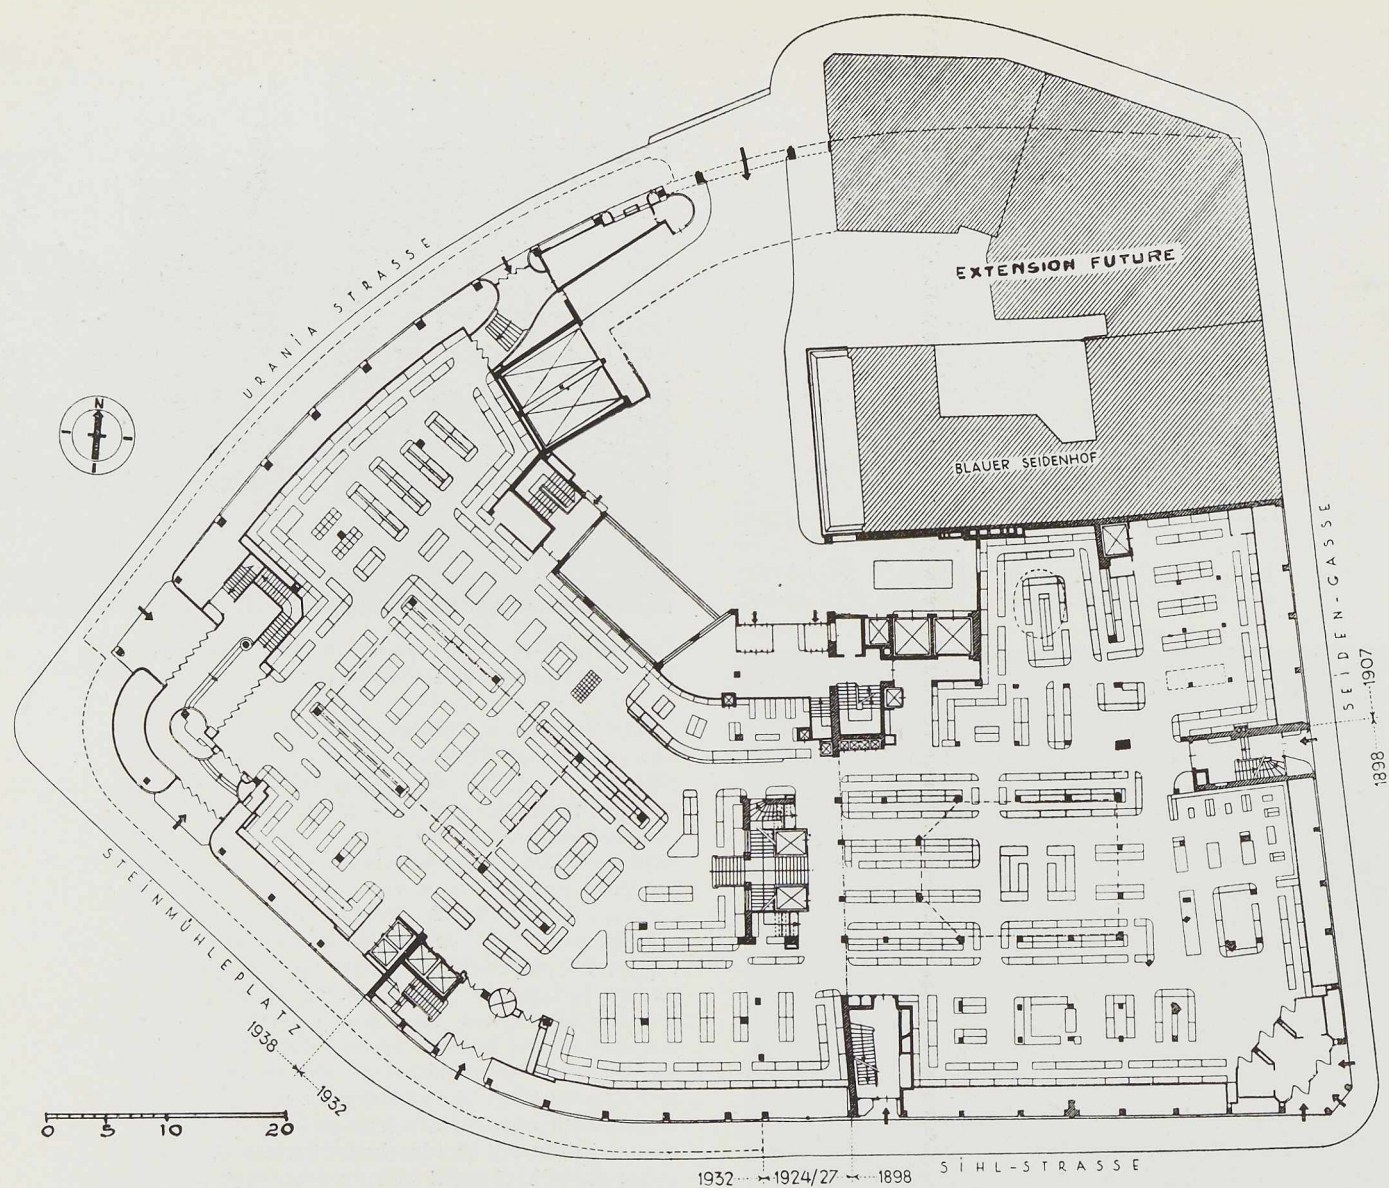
Plan du rez-de-chaussée de l'ensemble des bâtiments.
